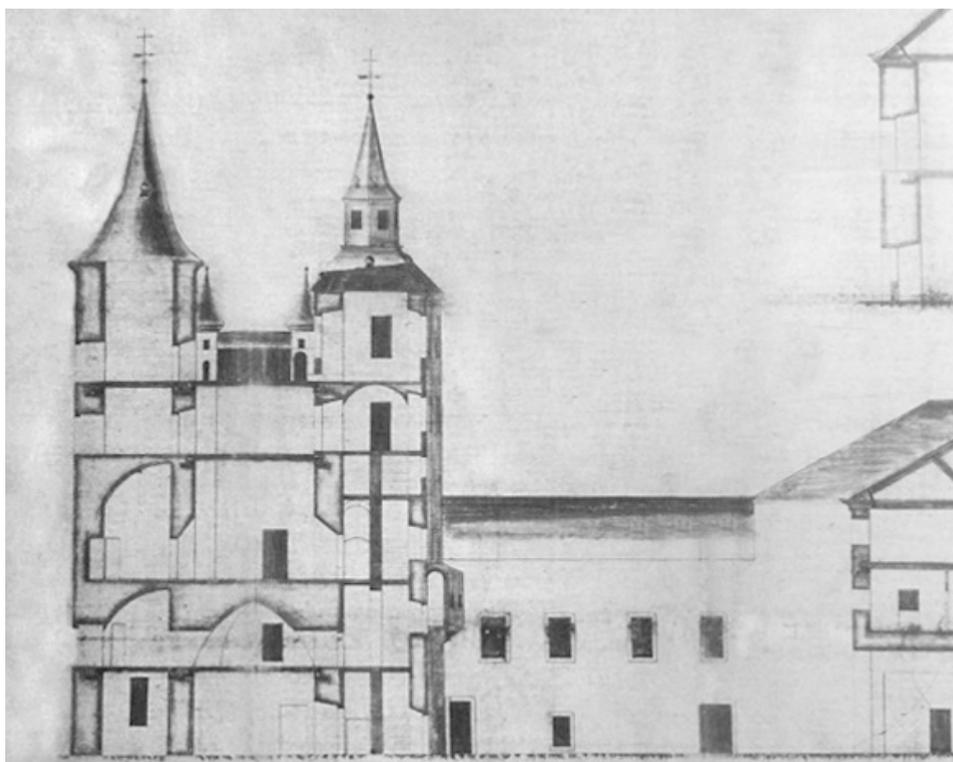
Alzado de los Ingenieros Sierra y Cayuela del lado sur del segundo patio. Detalle de la torre del homenaje y capilla (Cantalejo San Frutos, 1996: planimetría, proyecto 1).
